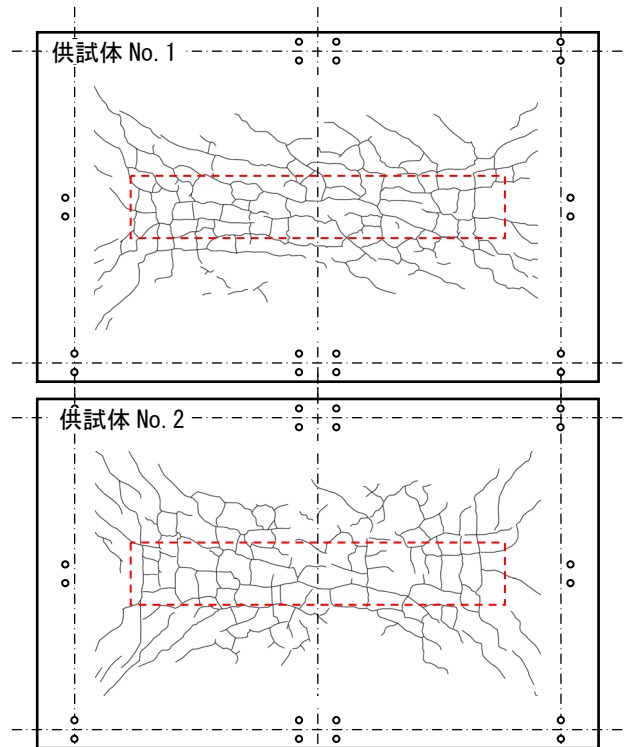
既設床版プレ载荷後の底面ひび割れ状況
